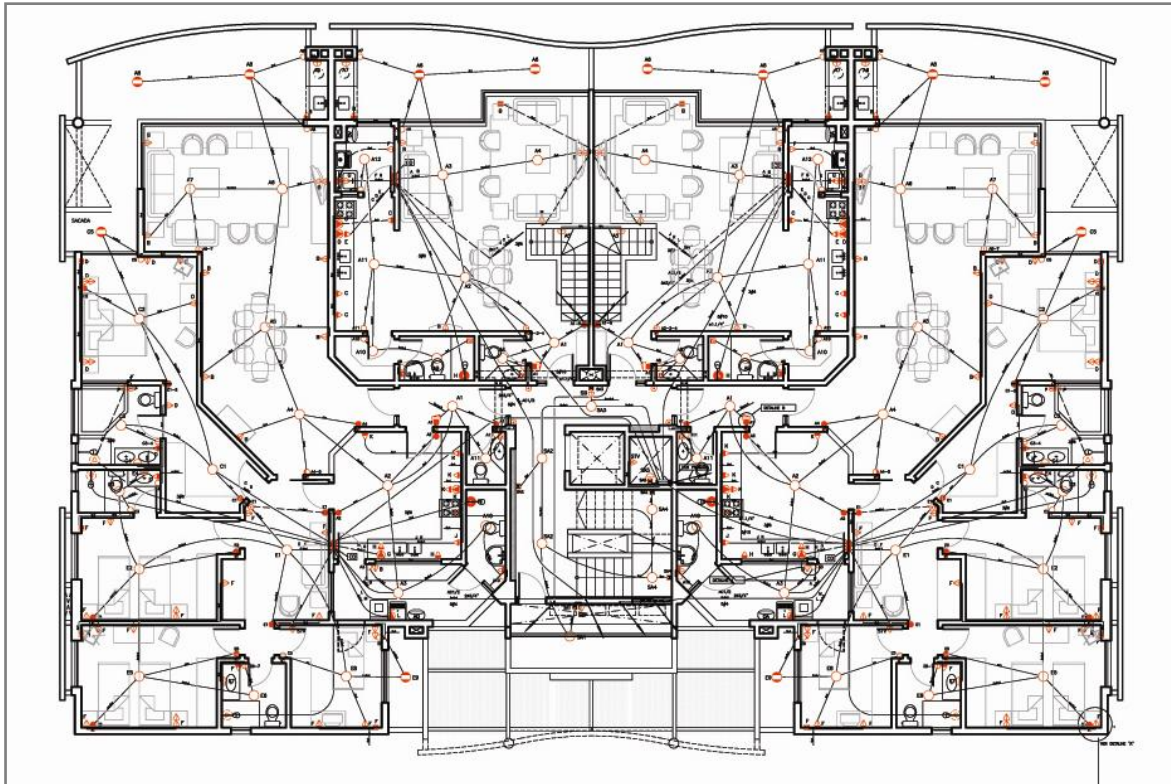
Planta baixa do projeto elétrico do pavimento tipo do bloco 02.
